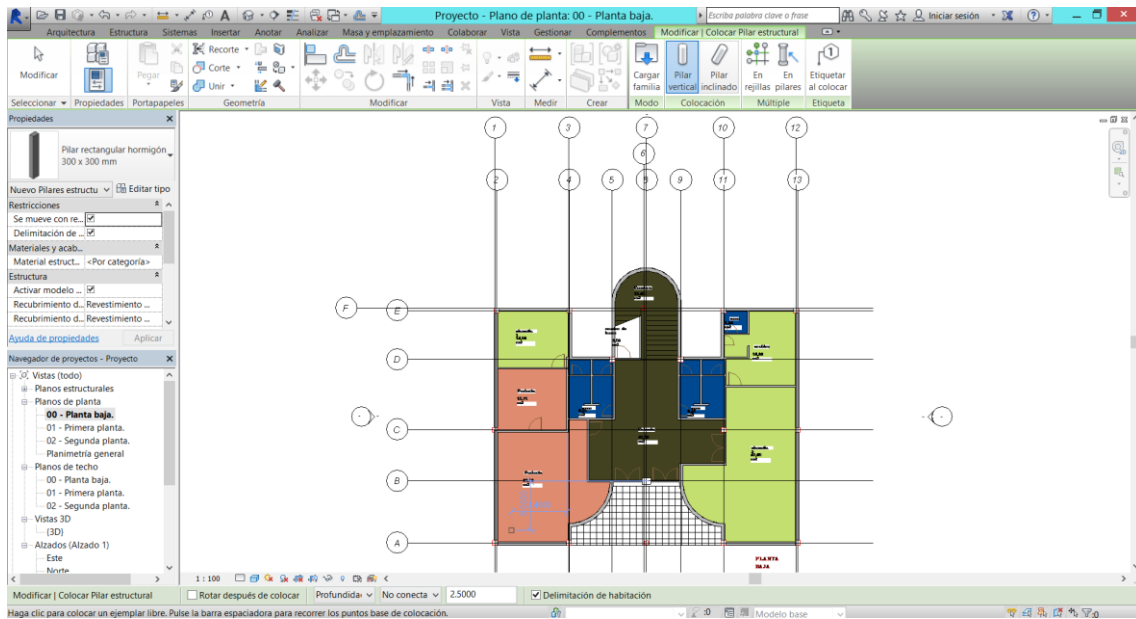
Plano de planta: 00 - Planta baja con rejillas. Fuente: Elaboración propia.
